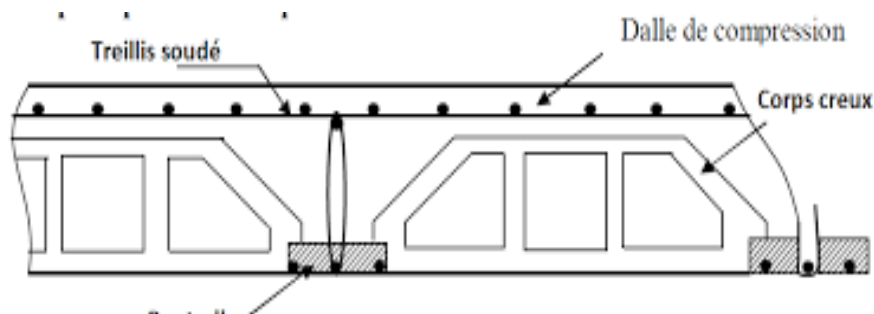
Coupe transversale d'un plancher à corps creux
